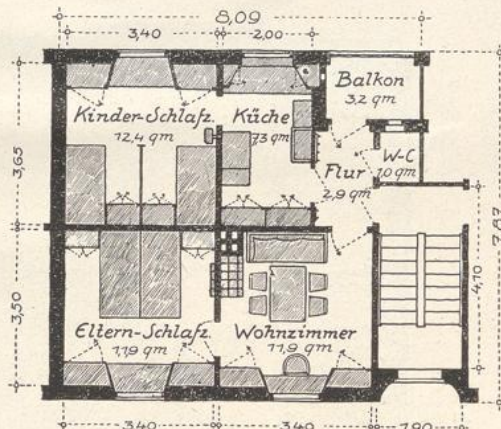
Etagenwohnung im Reihenhause mit eingebauten Kastentmöbeln (1:150)
